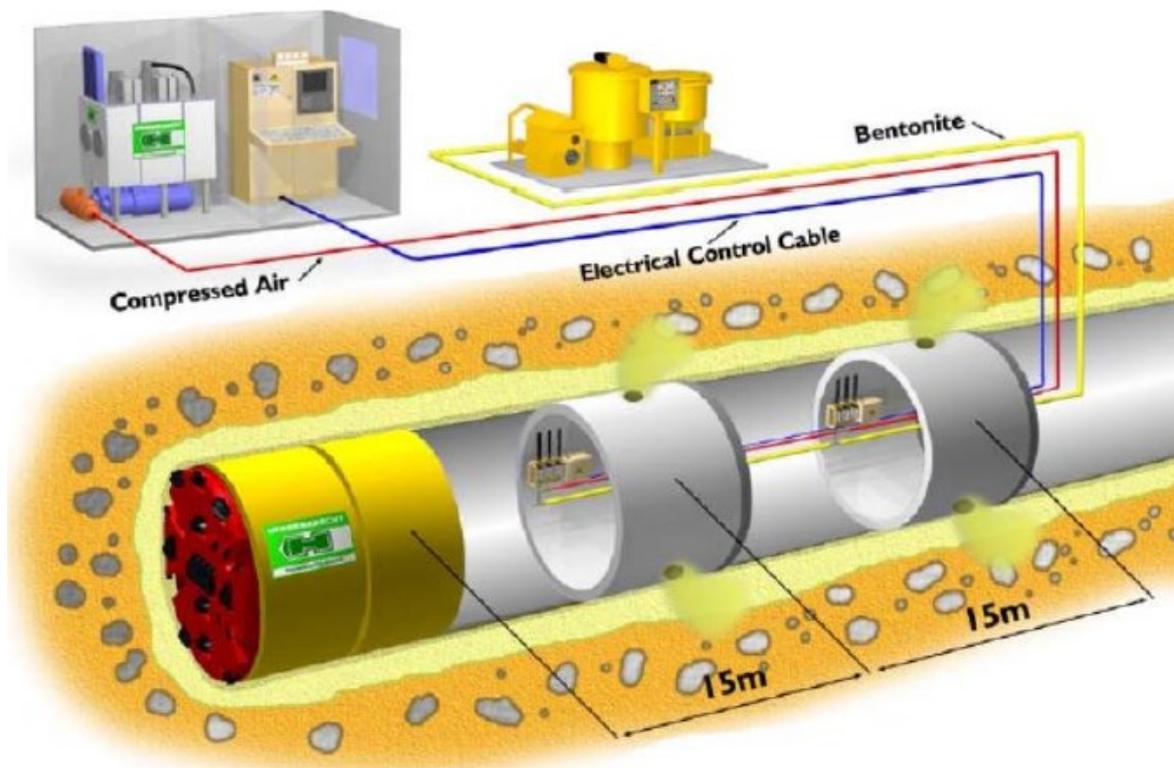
Schema esecuzione microtunneling con iniezione di fluido bentonitico.
